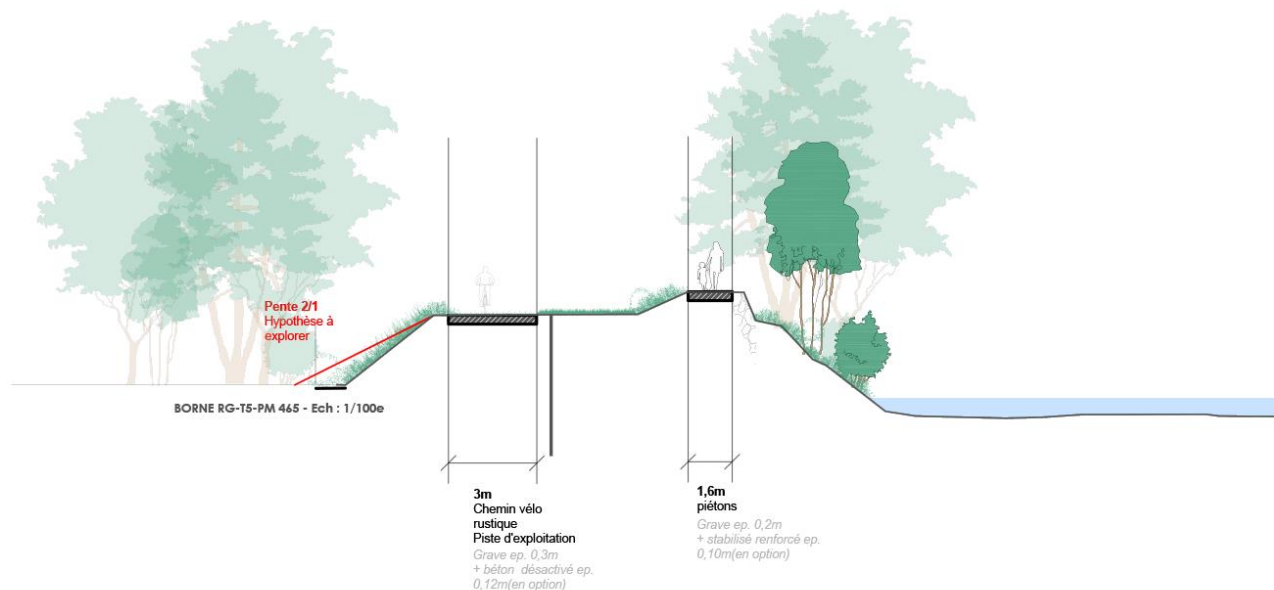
Profil 465 RG-T5 en aval du pont de Tucinge (Avenue Ravel)
